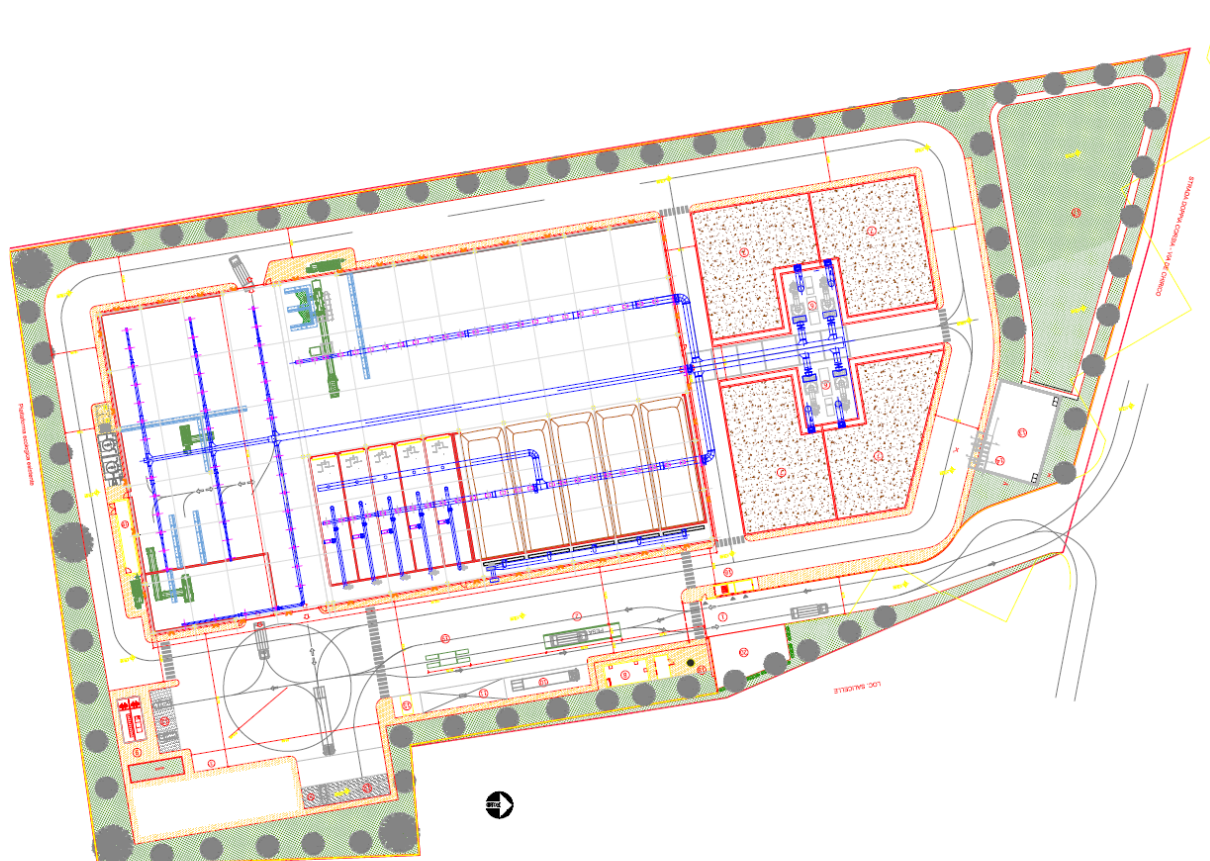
Layout dell’impianto di estrazione e trattamento dell’aria
